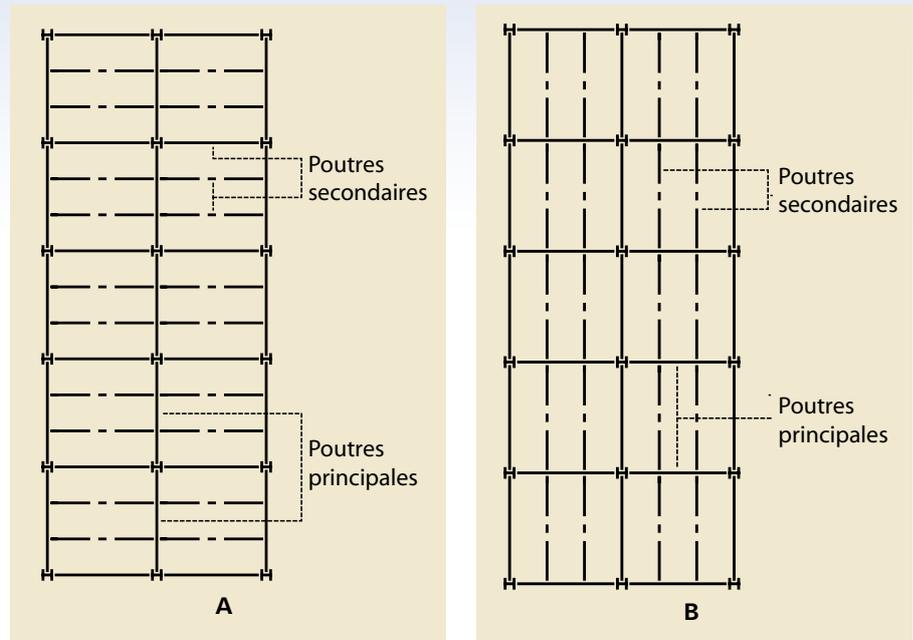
Différentes solutions pour la disposition des poutres en construction mixte
